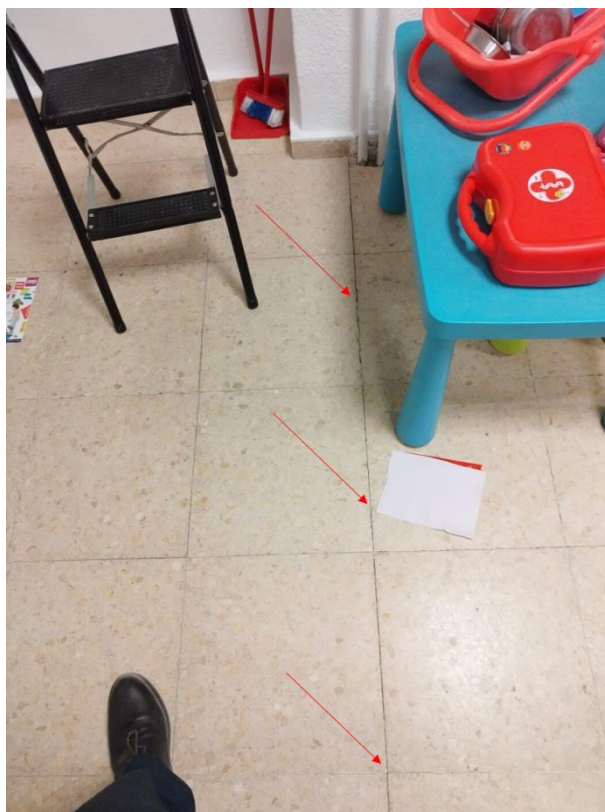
Abertura de las juntas del pavimento de terrazo en el arranque del voladizo en el que se aprecia la fisuración mostrada en las figuras 2 y 3 anteriores.
